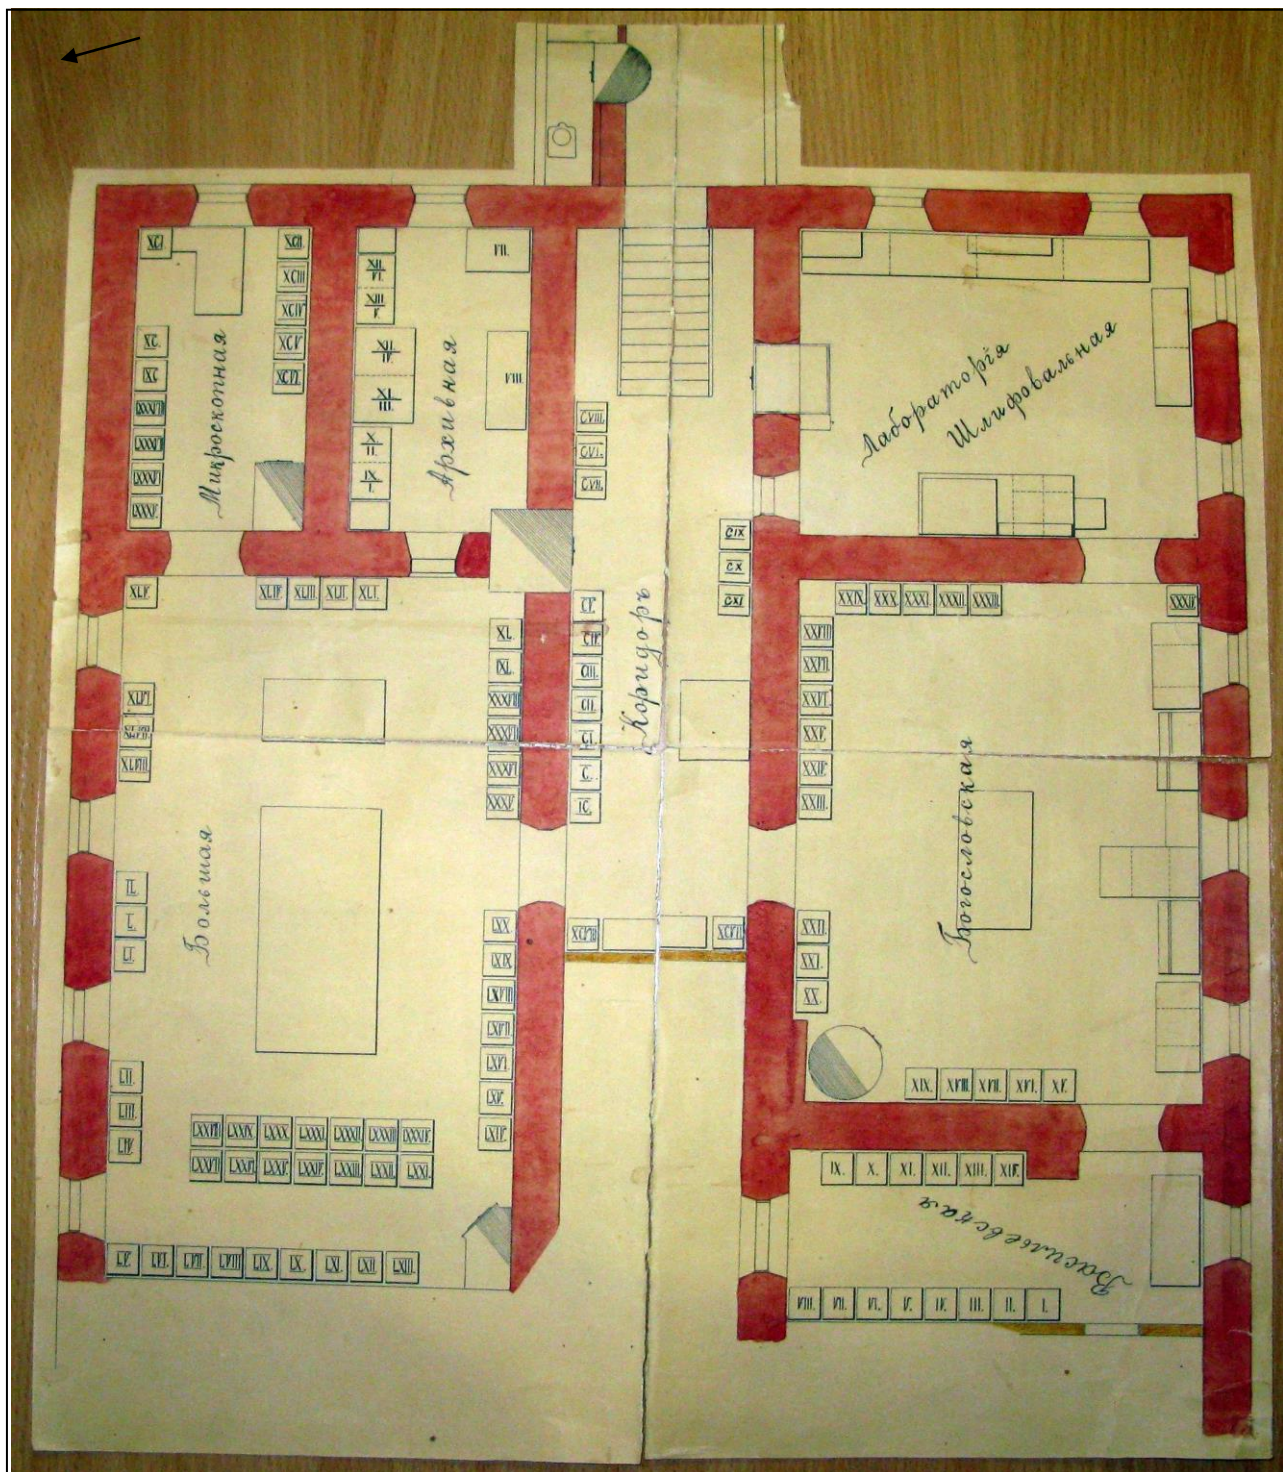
Фрагмент плана первого этажа. 1910-е гг.
